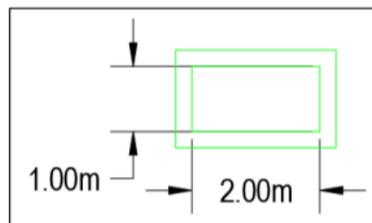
Sección propuesta para canal secundario en los primeros 50 m
